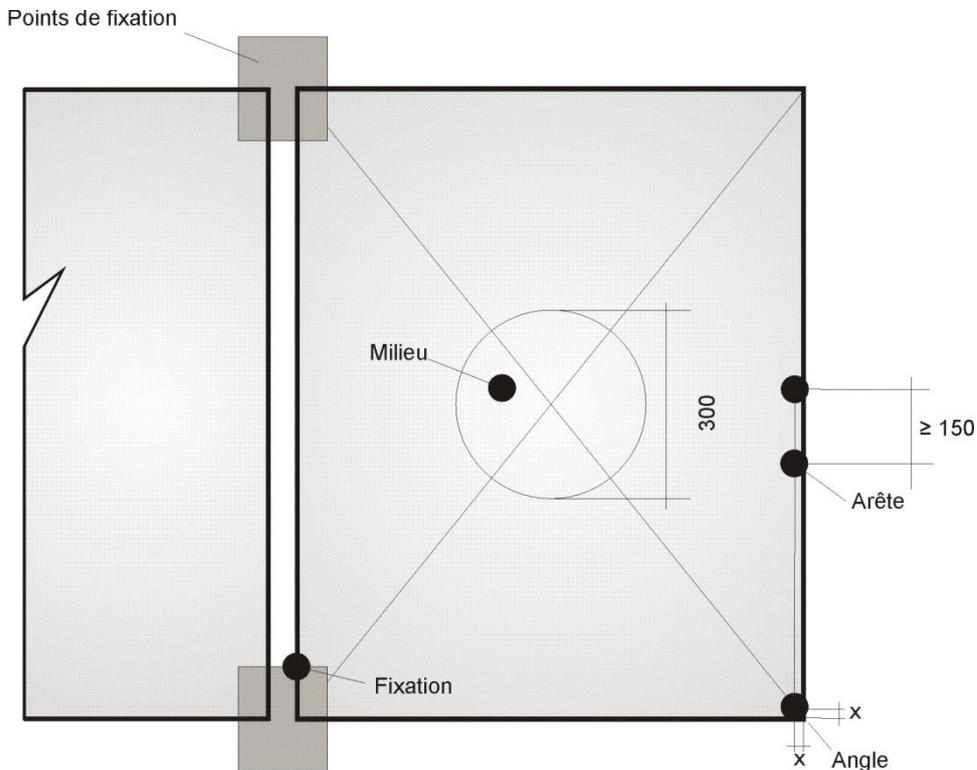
Points d'impact sur un vitrage de façade, vus en plan, à l'exemple d'un vitrage pourvu d'éléments de fixation extérieurs ($x = 1/5$ du diamètre du projectile; dimensions en millimètres).
